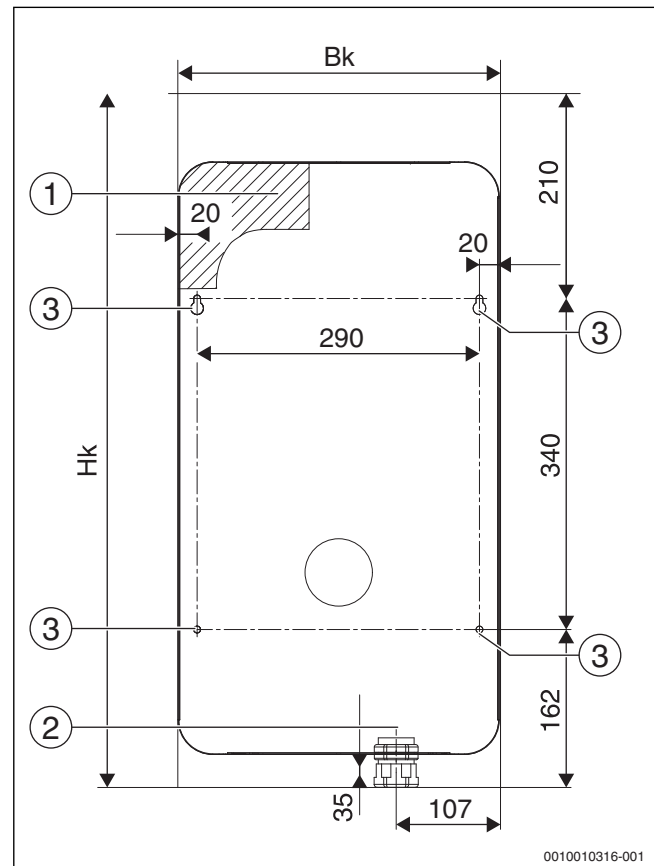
Abmessungen der Bohrungen für das Befestigen des Heizkessels an der Wand und für das Versorgungskabel beim Heizkessel Tronic Heat 3500 4-12 kW
